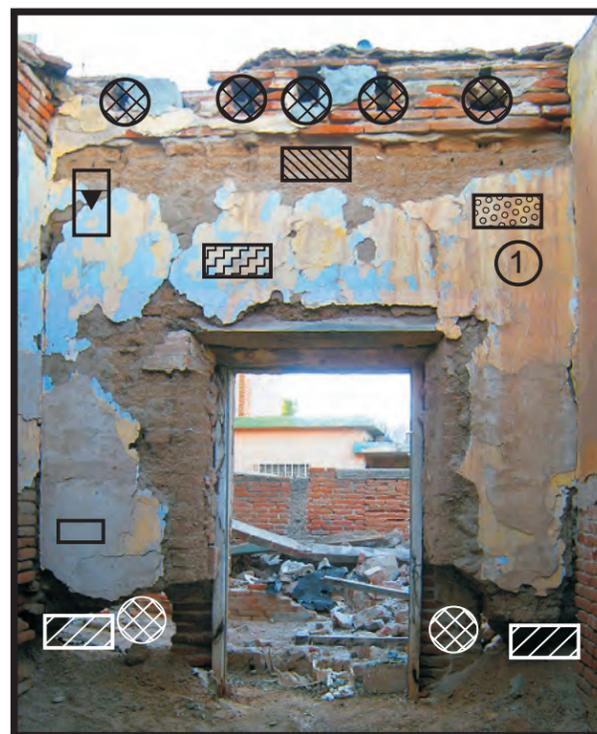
MURO AL NORTE. ACCESO AL PÓRTICO.
